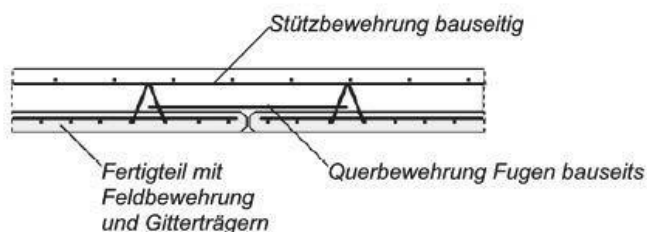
Querschnitt Elementdecke mit Ortbetonerfüllung, [Fouad, 2013], S. 247
